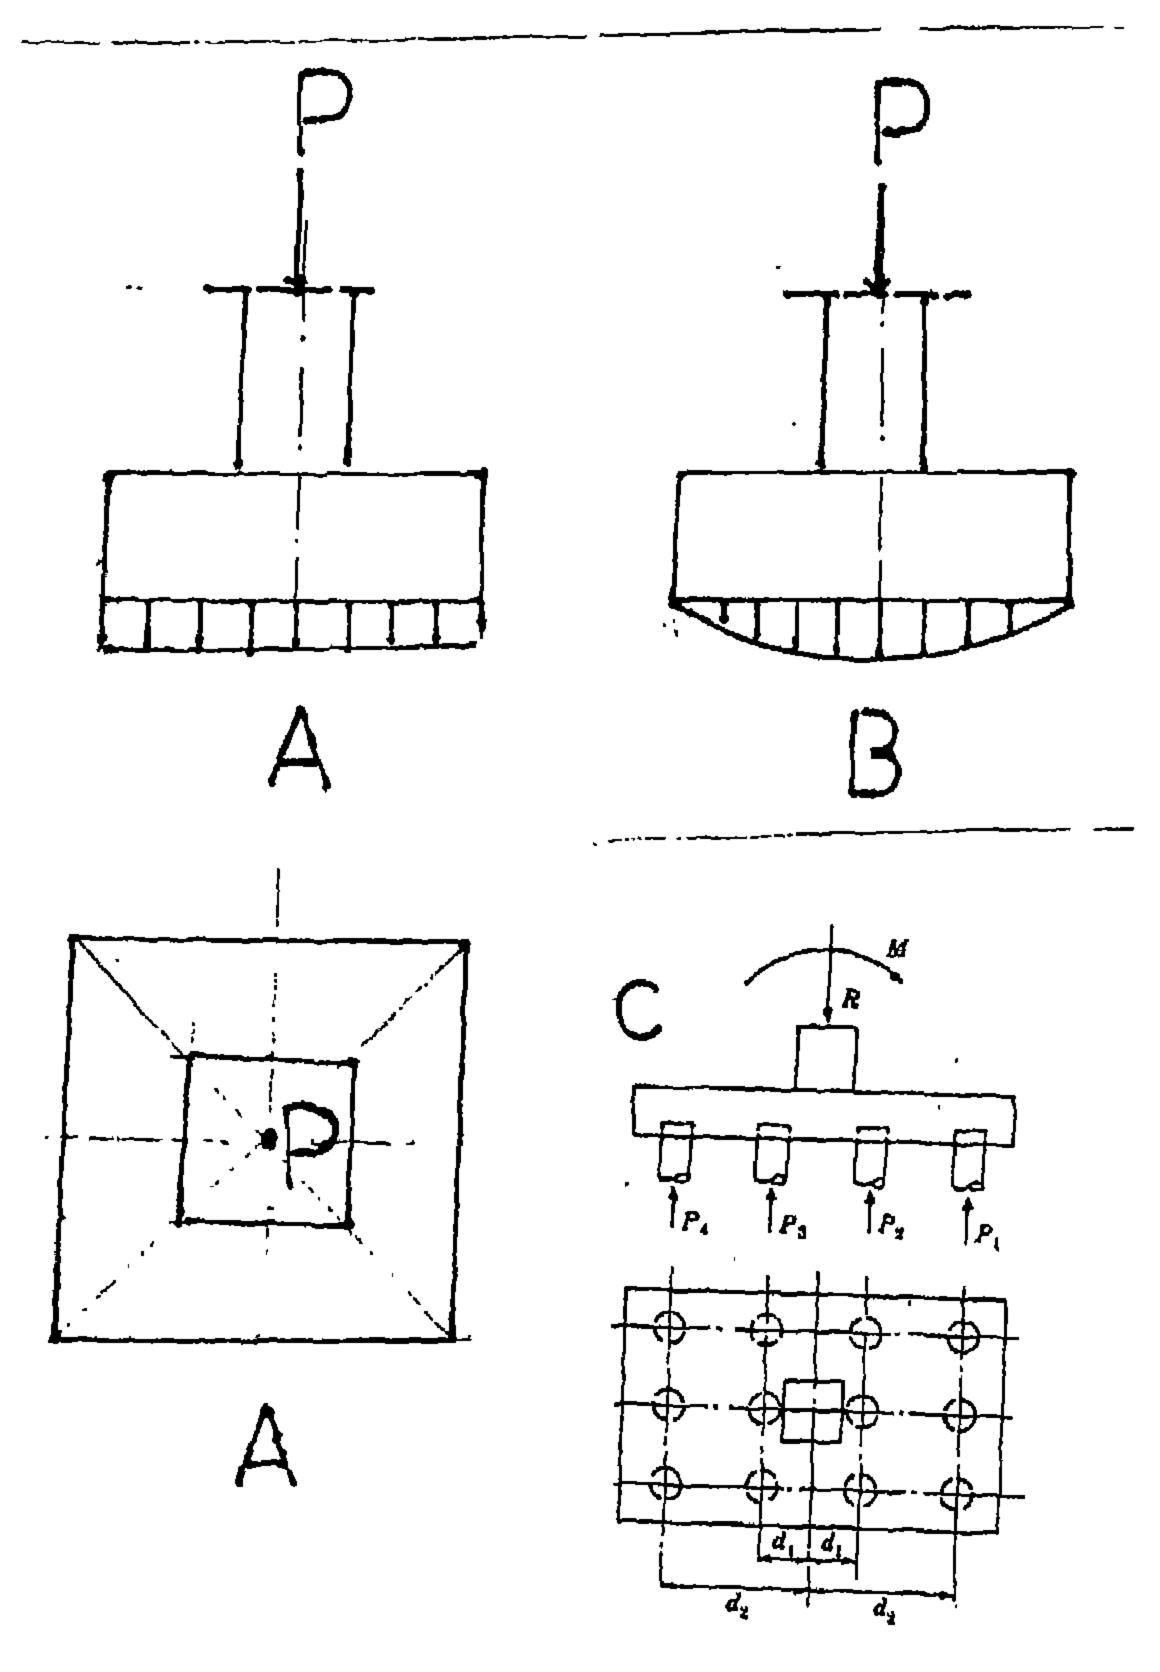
1) الأنواع المختلفة من الأساسات الخرسانية المستخدمة في تصميم المبانى الزراعية
